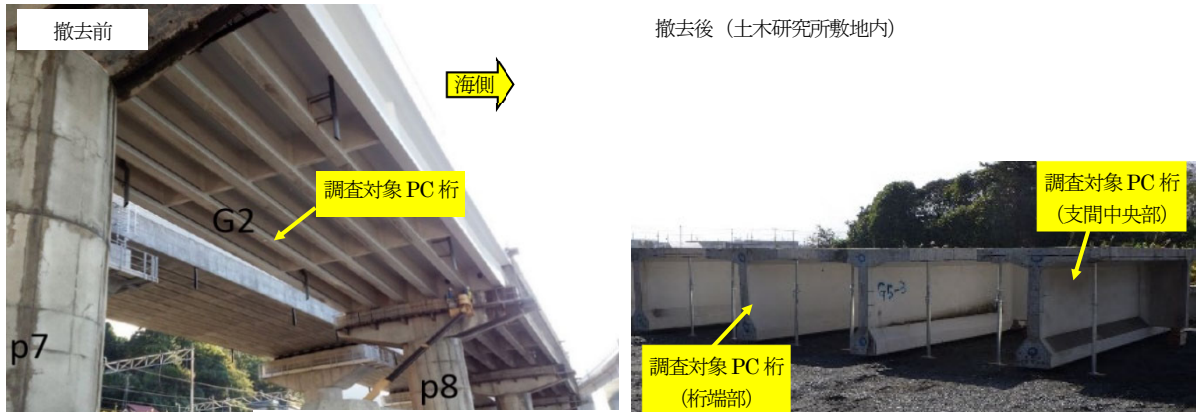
試験施工対象桁（第 8 径間）の撤去前と撤去後
